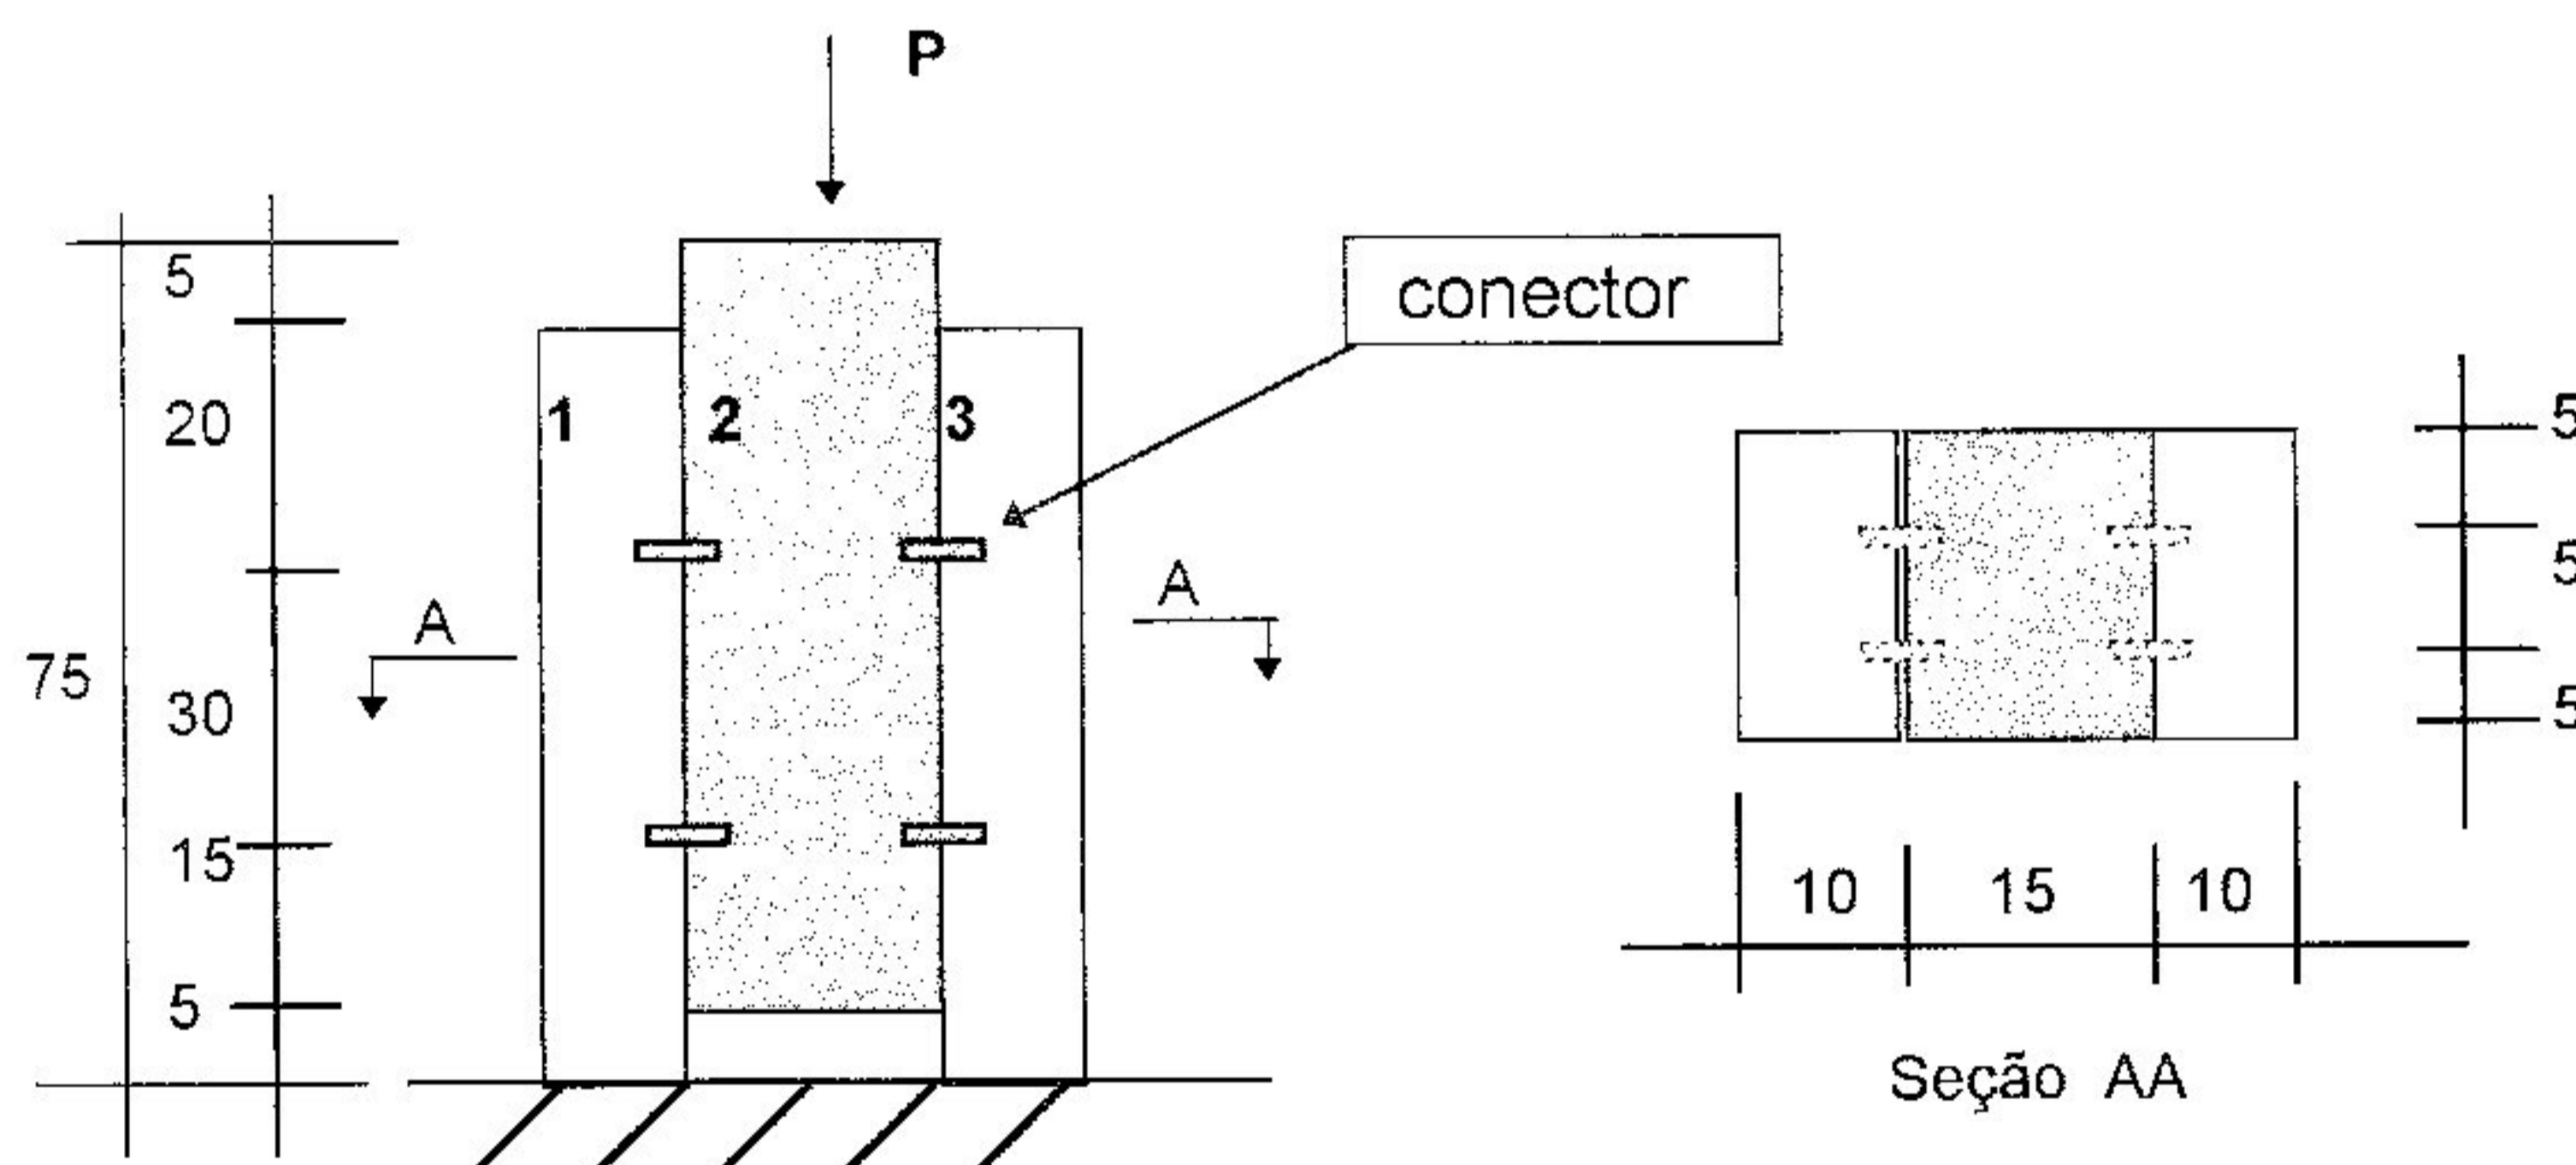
Corpo de Prova de Cisalhamento. Peças 1 e 3 em Concreto e peça 2 em Madeira. (Dimensões em cm)
